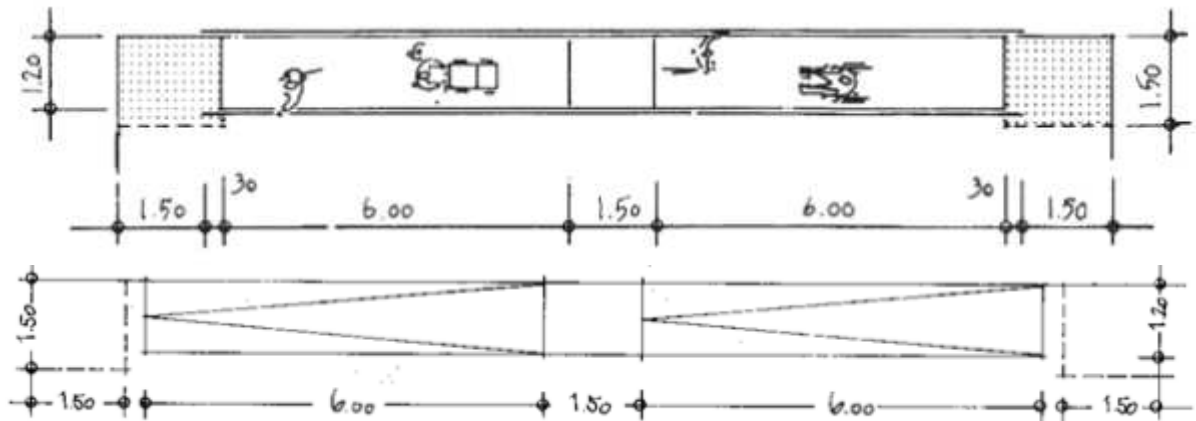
Rampe in Grundriss und Draufsicht
